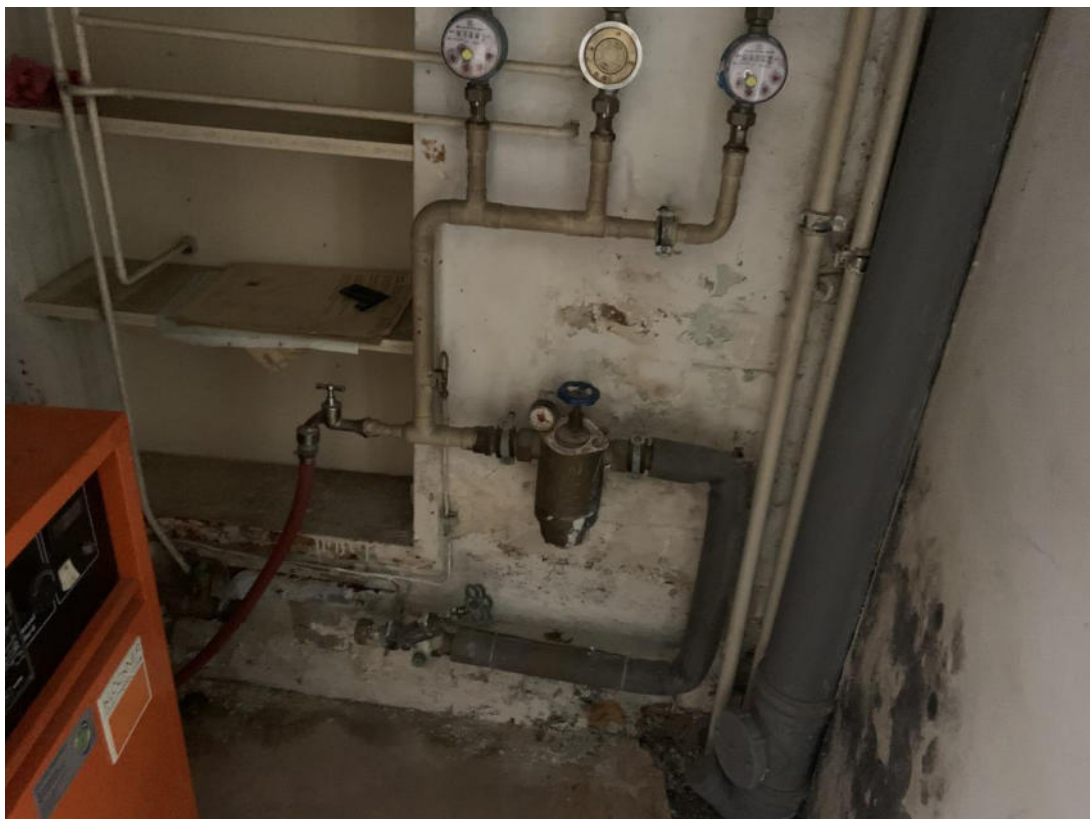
Heizung, Heizungsraum mit Feuchtigkeitsschäden
